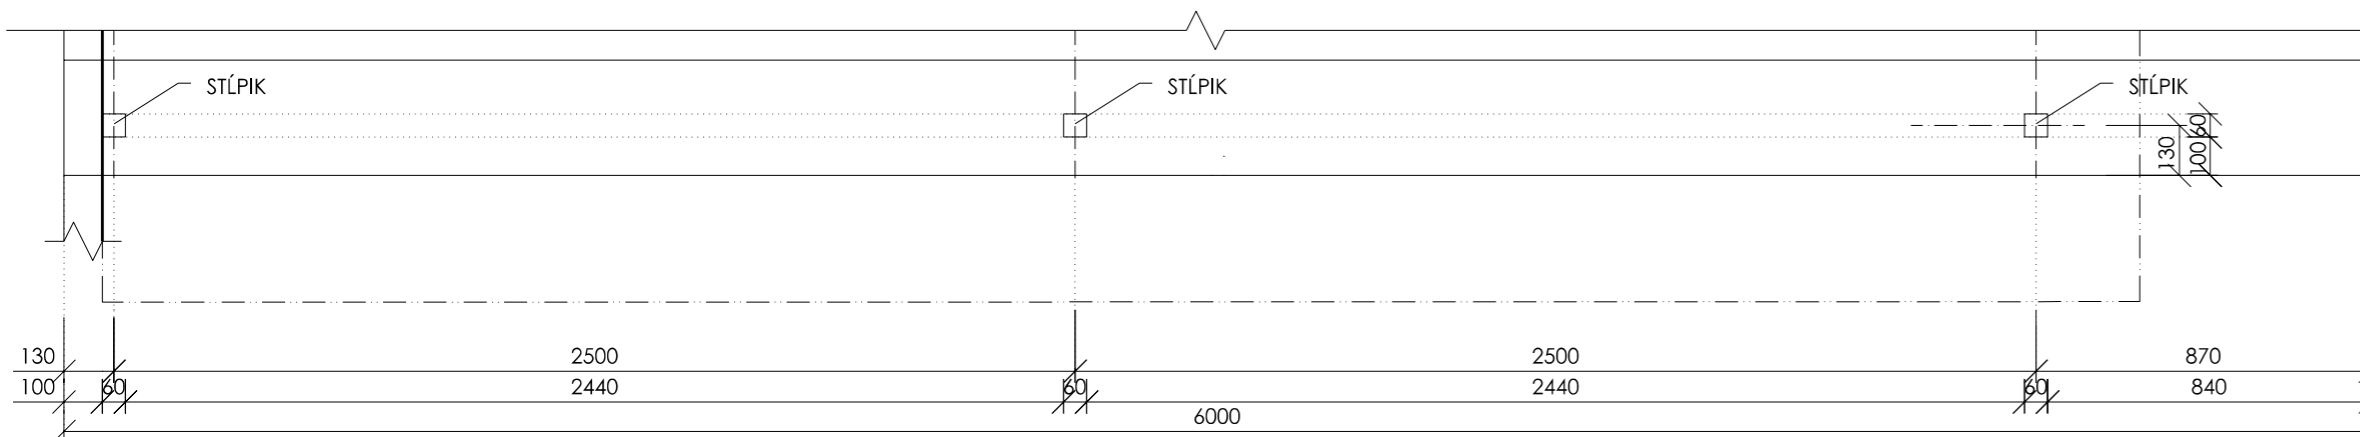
DETAIL RIEŠENIA KOTVENIA ZÁBRADLIA M 1:10 - KOTVENIE P
